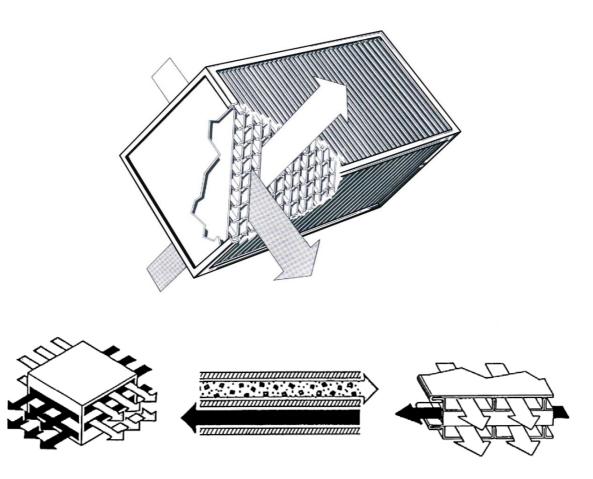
Схема устройства воздухо-воздушного рекуператора
